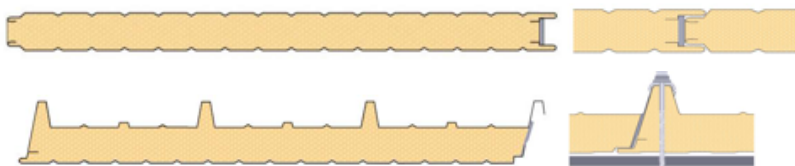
Ejemplo de paneles sándwich de pared y cubierta con chapas de acero y alma de poliuretano. Fuente: <https://www.panelsandwich.com>
